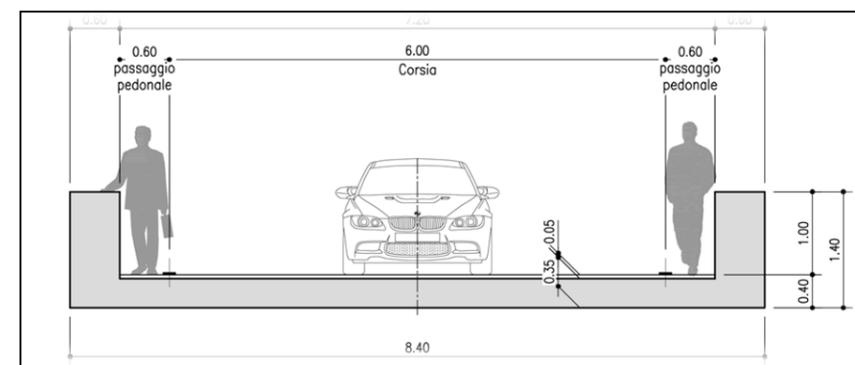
Sezione trasversale tipo della rampa elicoidale
